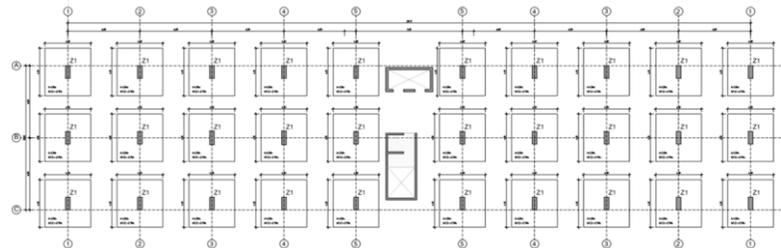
Plano de cimentación FUENTE: Elaboración propia
